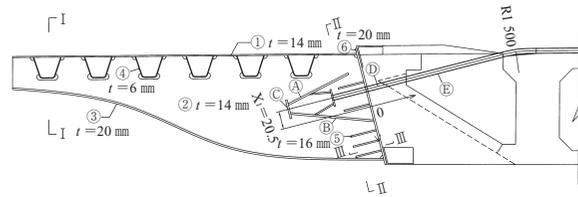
大連北東跨道橋の標準断面図（単位：mm）
